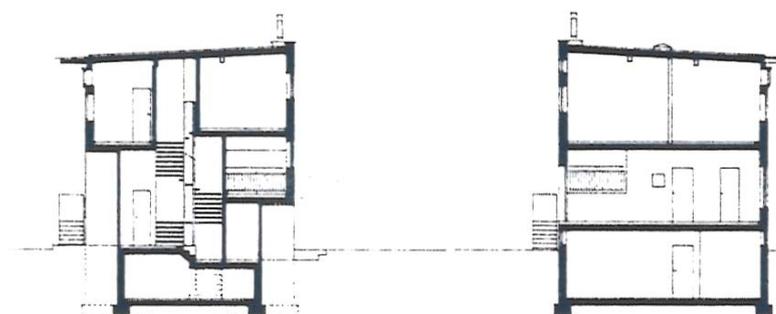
Gebäudeschnitt durch den 2-geschossigen Hausteil (l)
